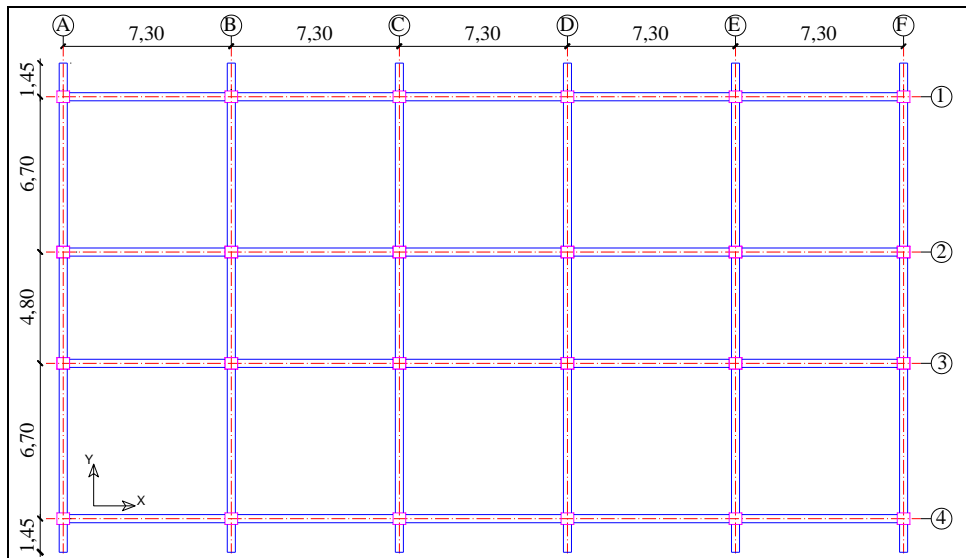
Vista en Planta, Edificio Residencia (ESPE).
